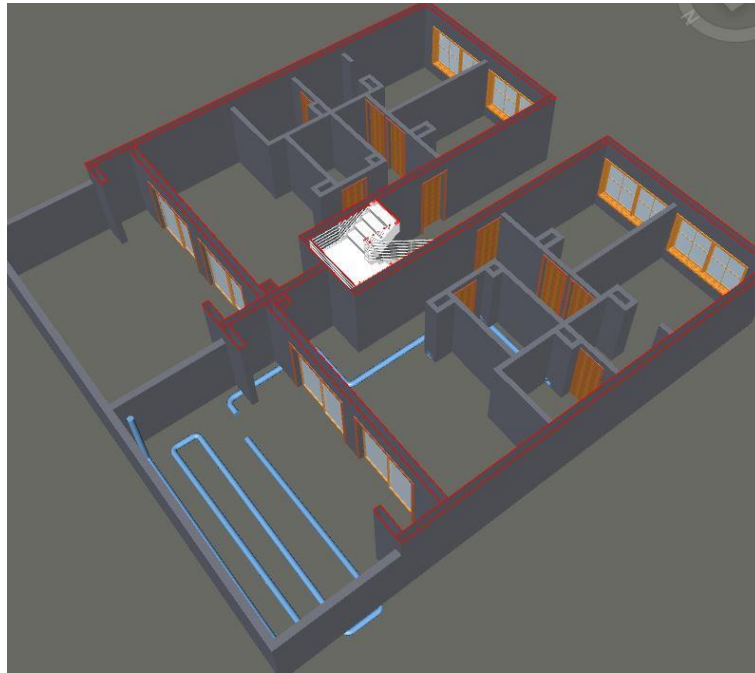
Vista en planta de la instalación del ICTA. Elaboración propia.
